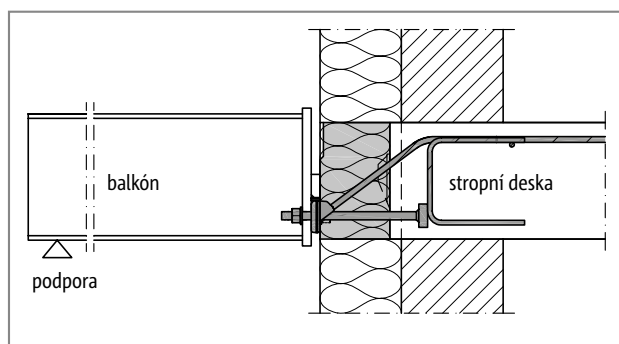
Schöck Isokorb® XT typ SQP: Napojení na železobetonovou stropní desku; stěna z monolitického betonu
